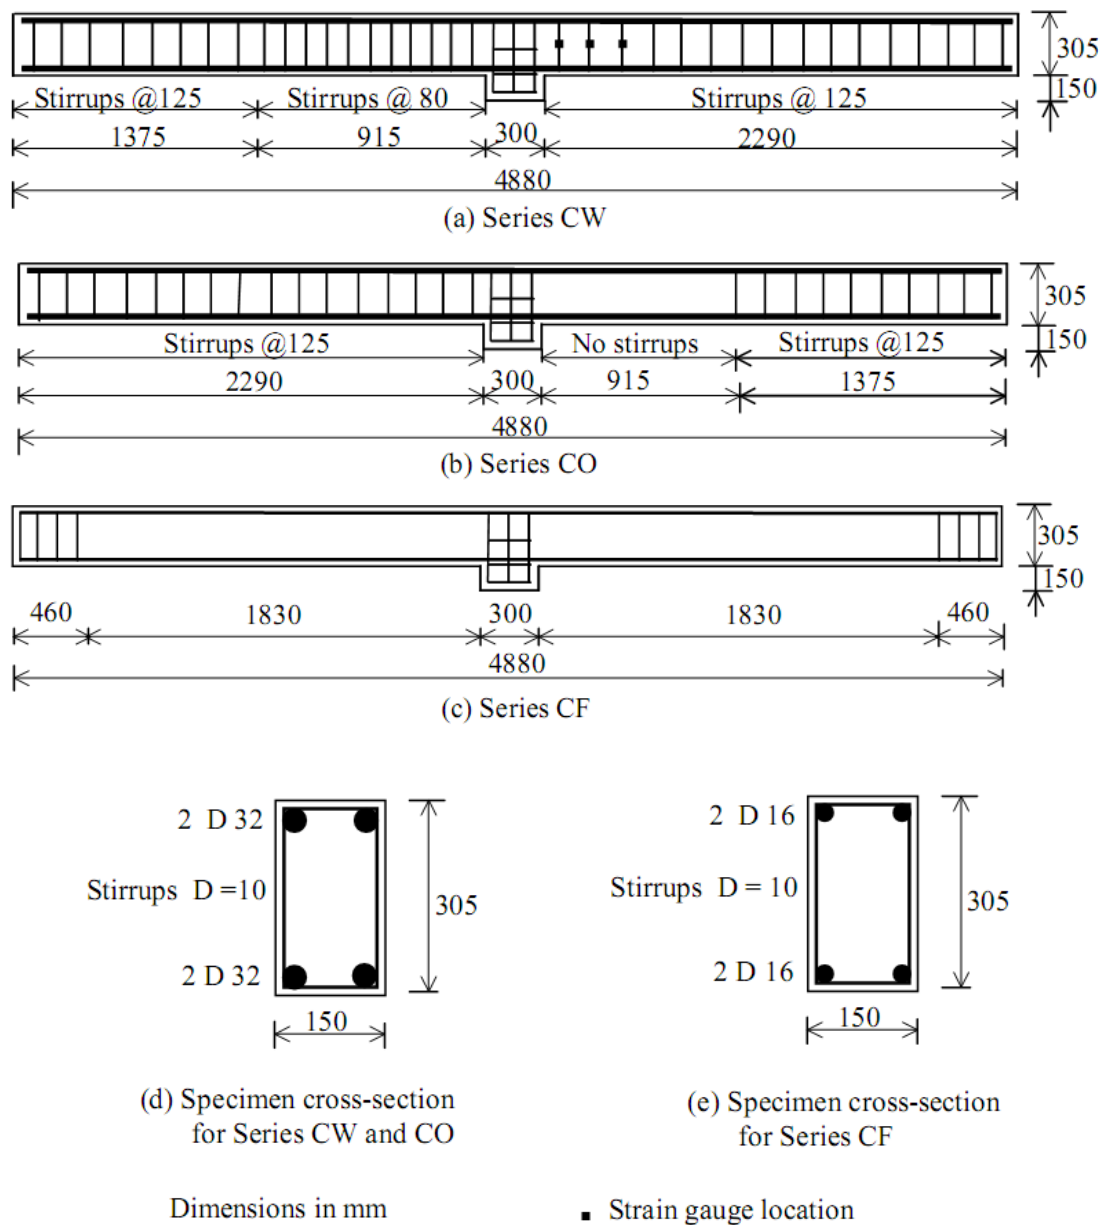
Détails et dimensions des poutres ; Essais de Khalifa et al [89].
